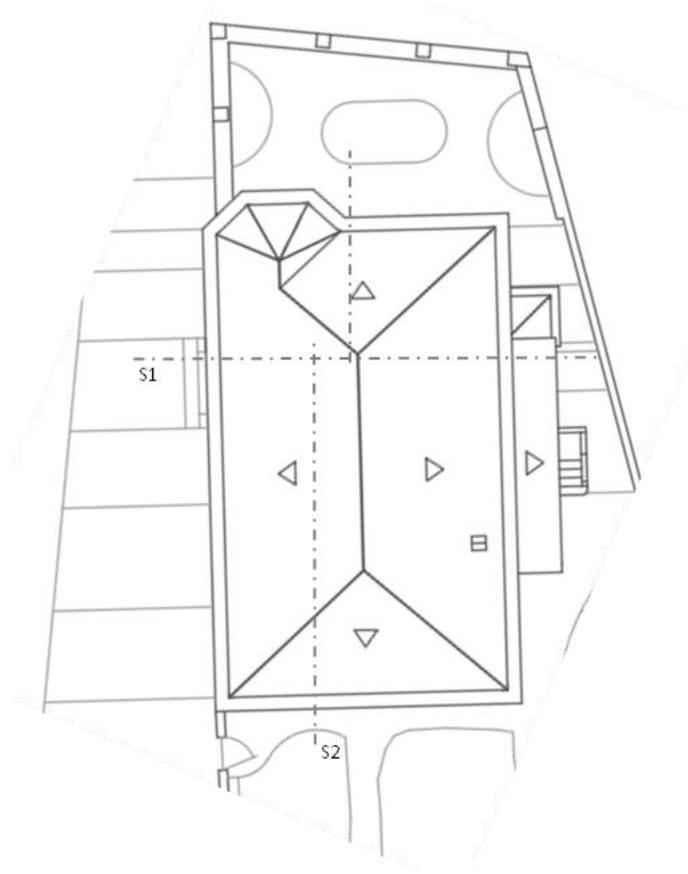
15 - Planta de cobertura existente, sem escala (Fonte: de autor).
